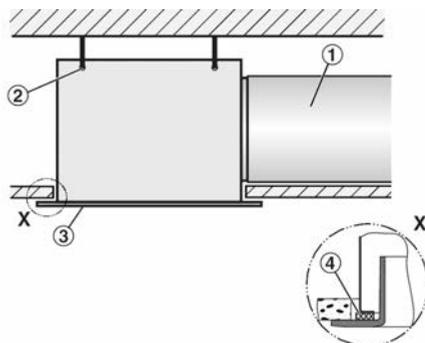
Montage à ras du plafond avec caisson de raccordement carré
